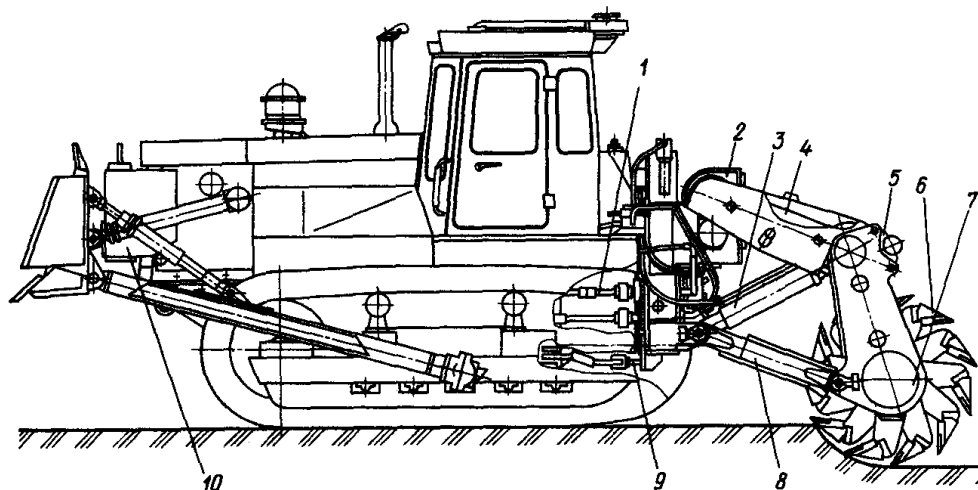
Машина ДП-31АХЛ послойного фрезерования грунта
